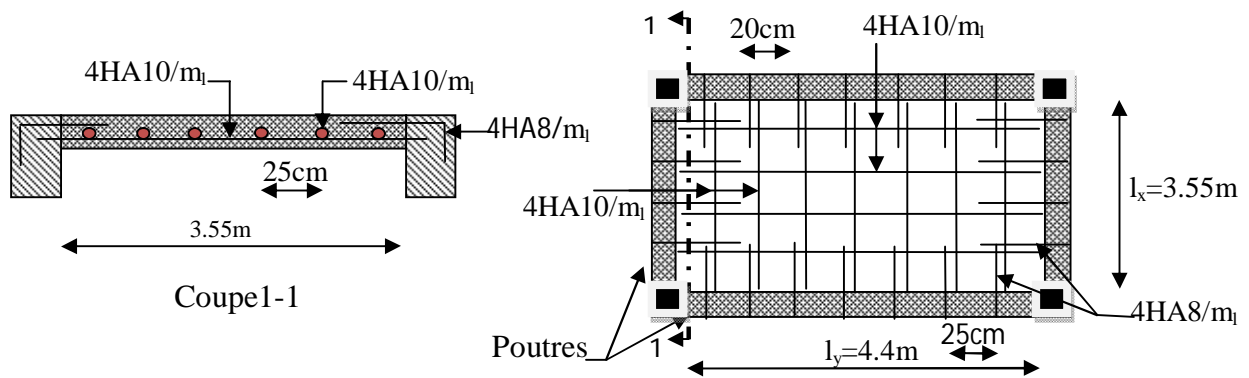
schéma de ferrailage de la dalle sur 4 appuis.
